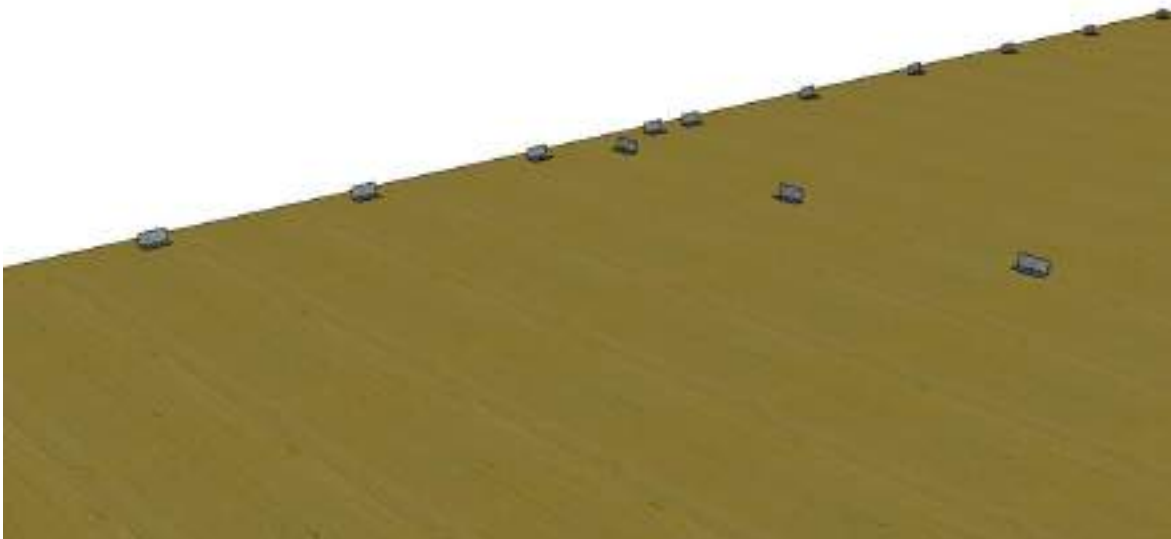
Mise en œuvre du plancher bois de type CLT / Vissage sur les traverses hautes en tête de panneau
